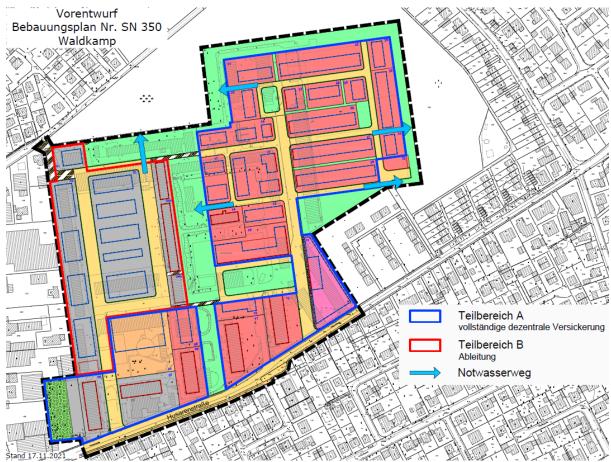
Vorentwurf Bebauungsplan mit Entwässerungsbereichen A und B
